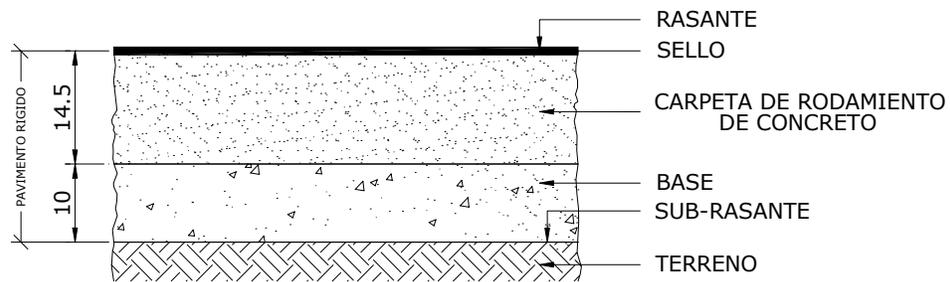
Sección de Pavimento de Concreto Hidráulico
